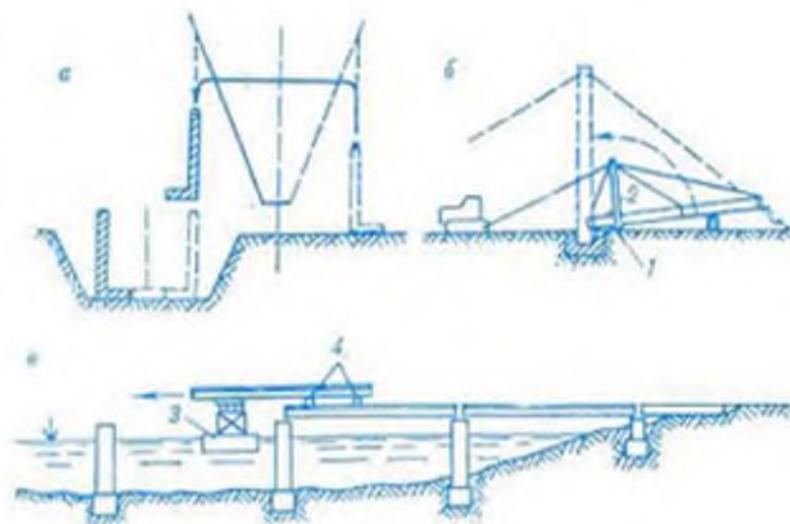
Монтаж гидротехнических сооружений. Способы перемещения и установки на место деталей при монтаже сборных железобетонных сооружений: а — вертикальным подъёмом (подрачиванием), б — установка поворотом (опрокидыванием), в — монтаж продольной движимой; 1 — точка поворота, 2 — вспомогательная стрела, 3 — конгон, 4 — катки.
